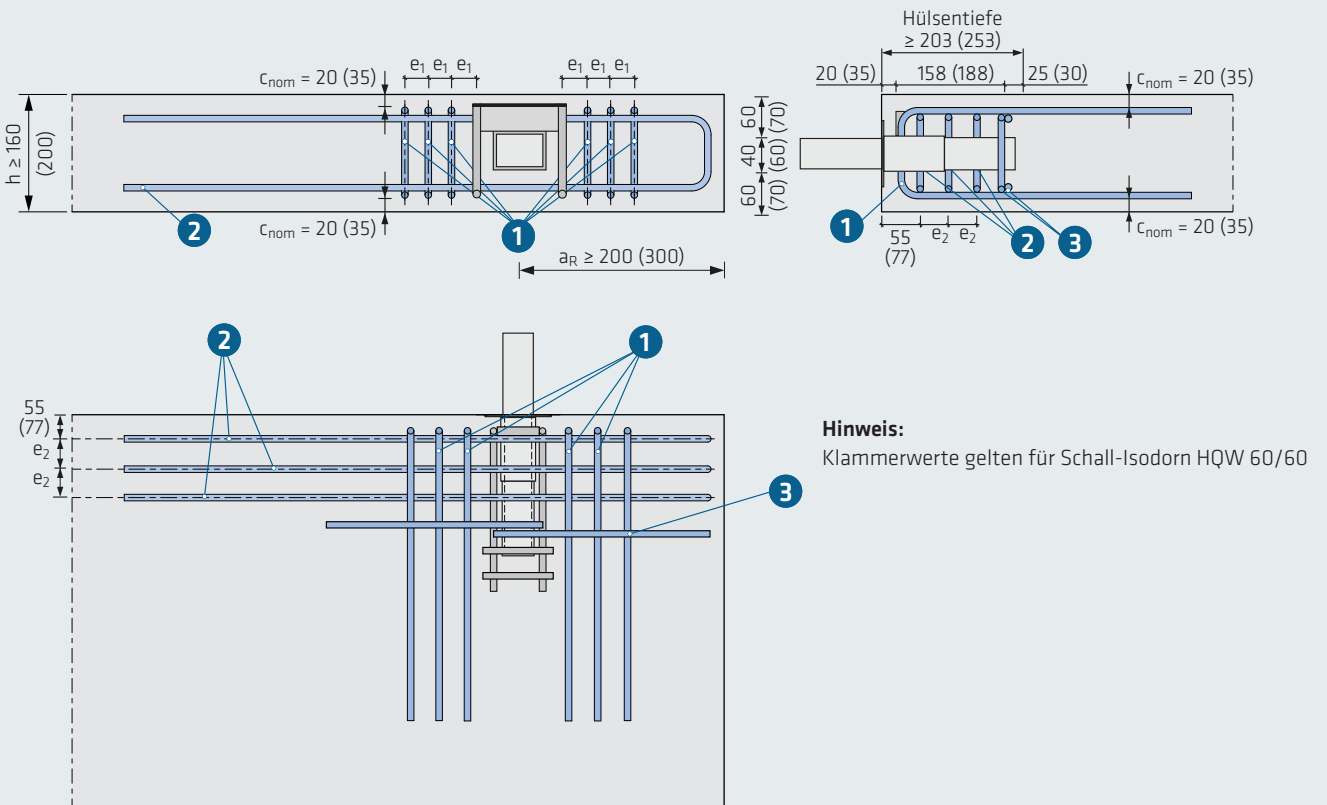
Beispiel einer bauseitigen Bewehrung am Bauteilrand
